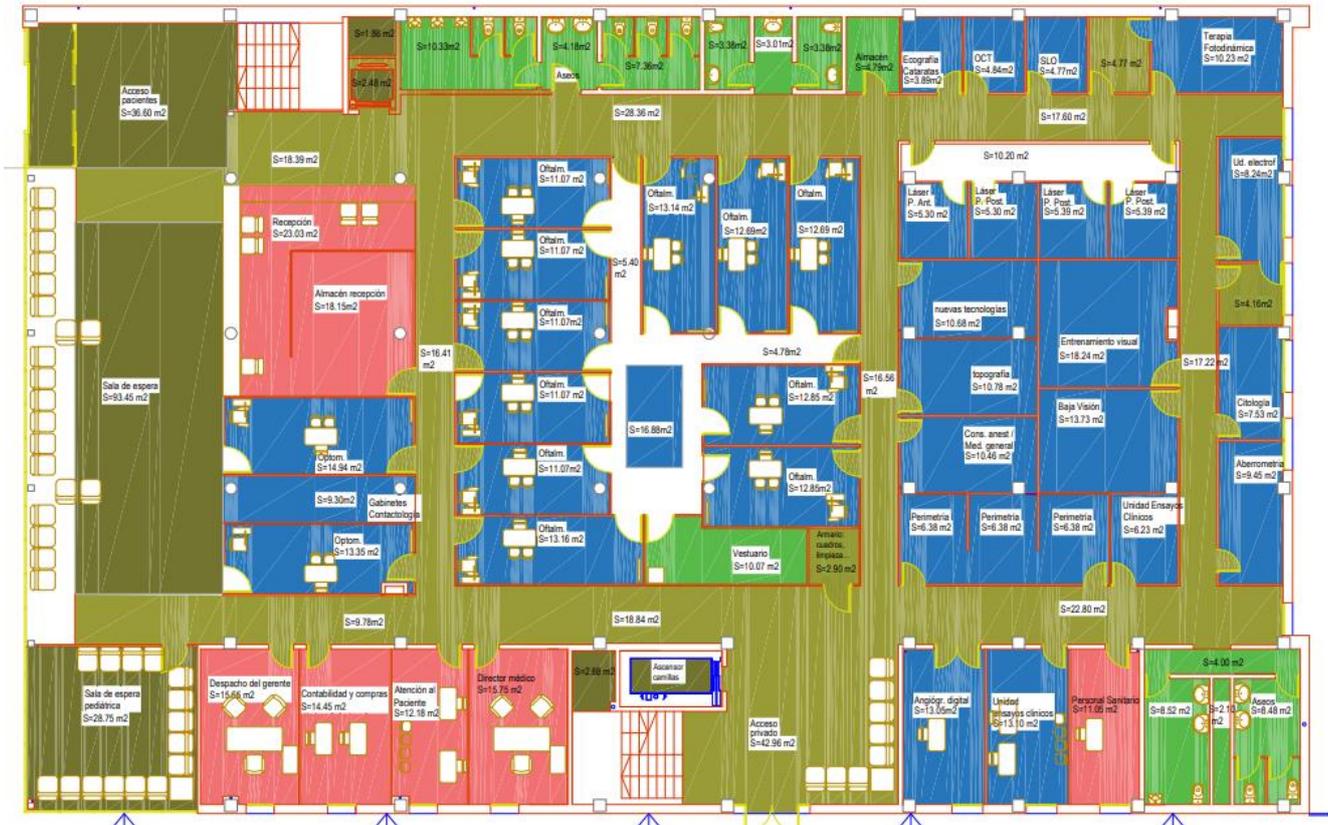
Vista de planta del nivel planta baja subdividida por zonas.
